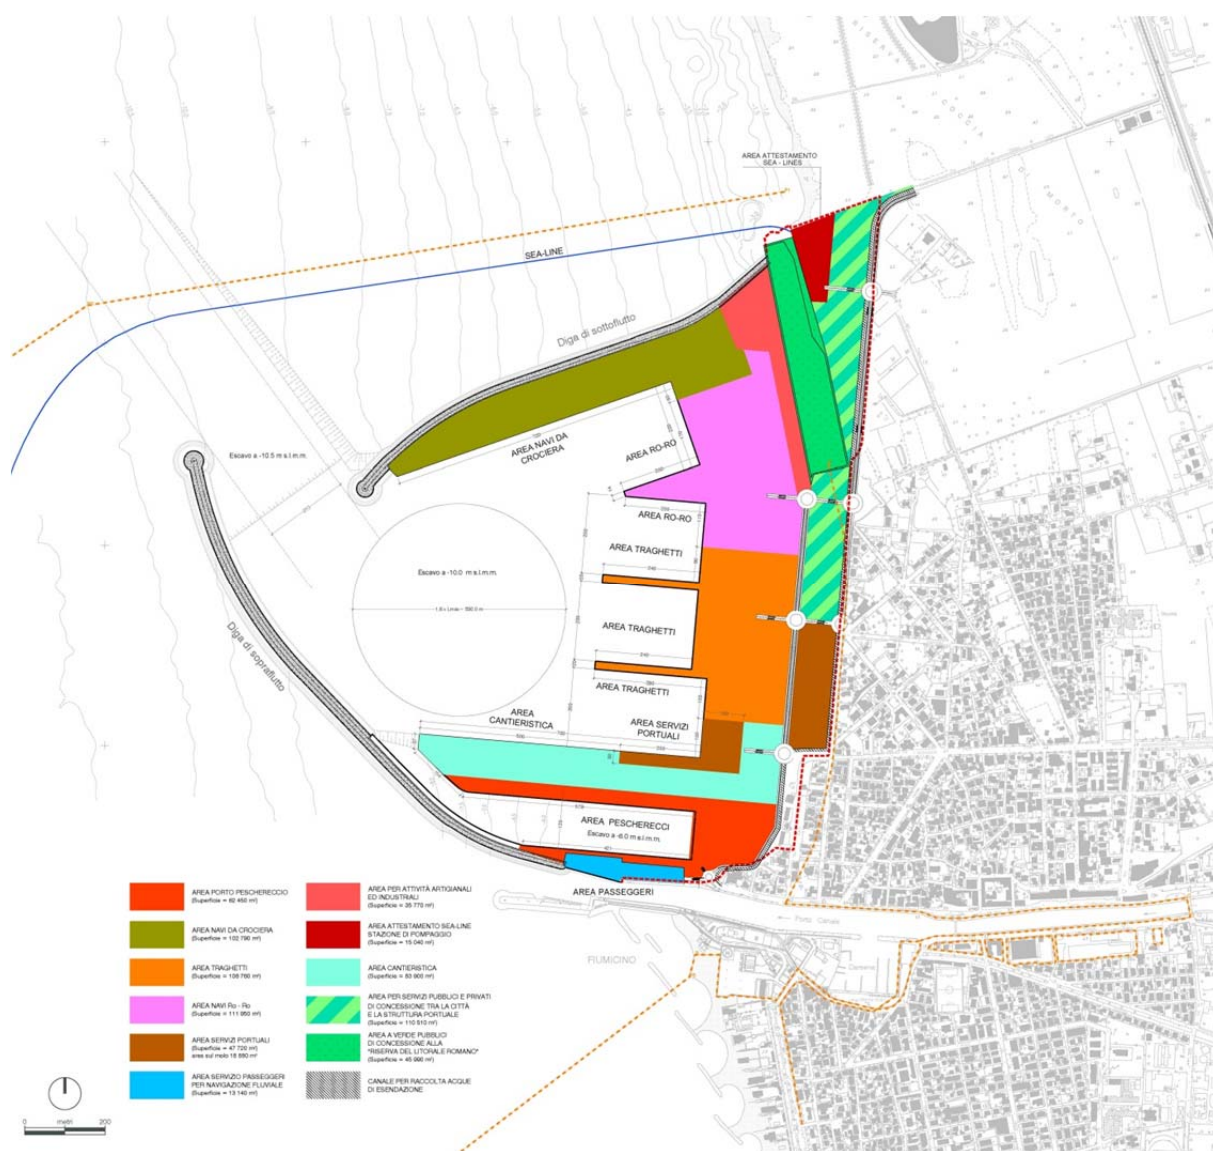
Planimetria del P.R.P. vigente con ottimizzazione della localizzazione della funzione crociera
